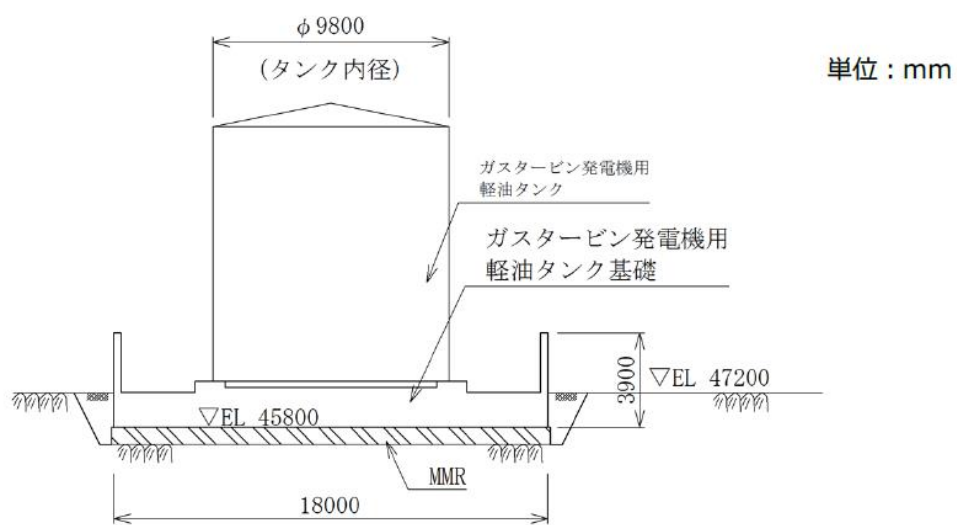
ガスタービン発電機用軽油タンク基礎 断面図 (B-B断面)
